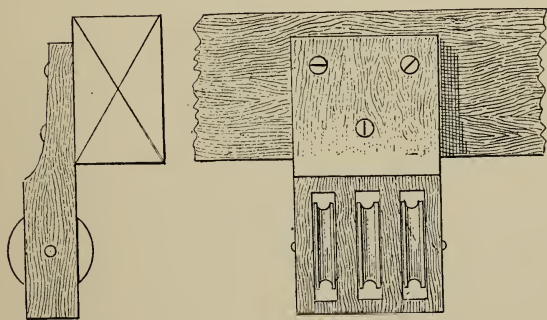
Moufle de famille pour l'équipe des plafonds.
